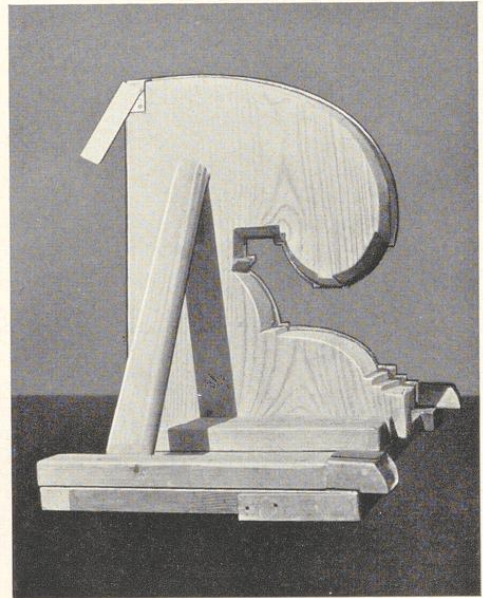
Die Eckschablone von der Rückseite gesehen. Der Profilausschnitt konisch gearbeitet
